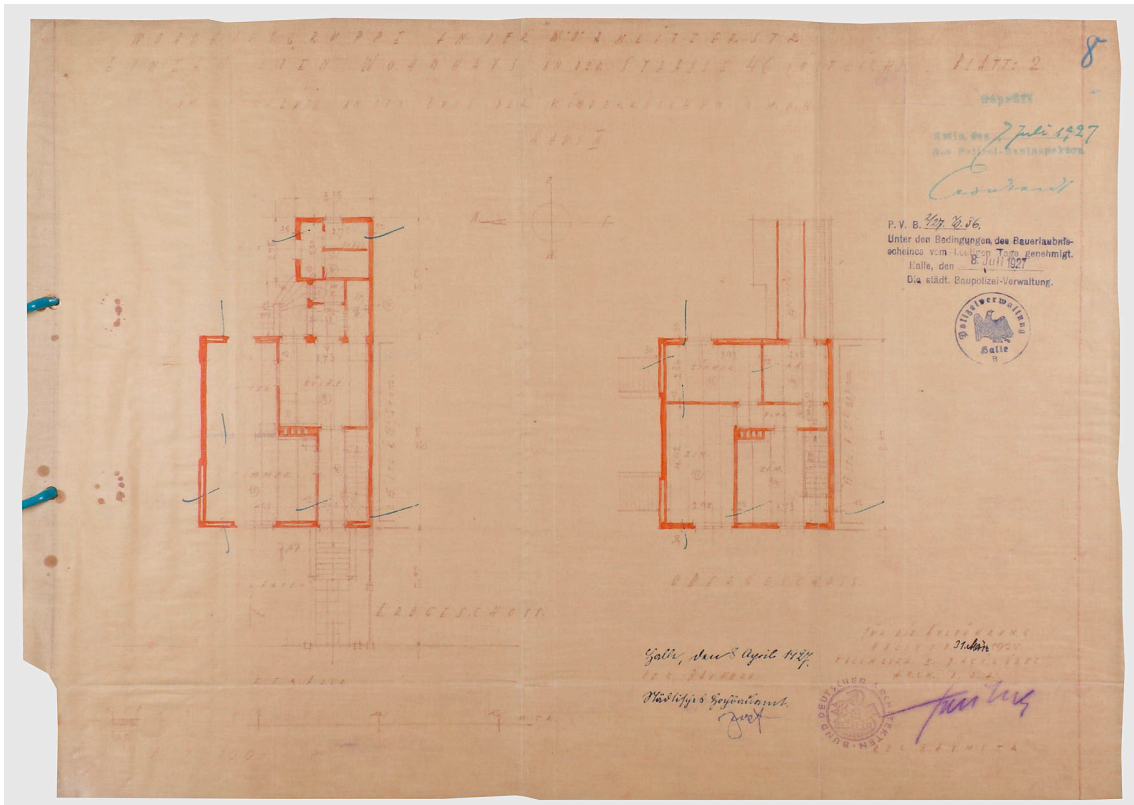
Wohnhaus in der Benkendorfer Straße 1a in Halle, Grundrisse Erd- und Obergeschoss, datiert 31. März 1927.
